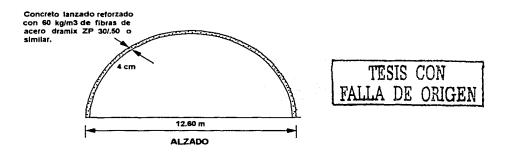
Colocación de una capa primaria de concreto lanzado reforzado con fibras de acero, hasta alcanzar un espesor de 4 cm.
